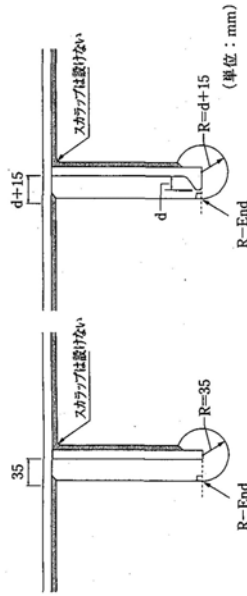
平板リブまたはバルブプレートリブと中間横リブまたは横げたとの交差部構造の標準
